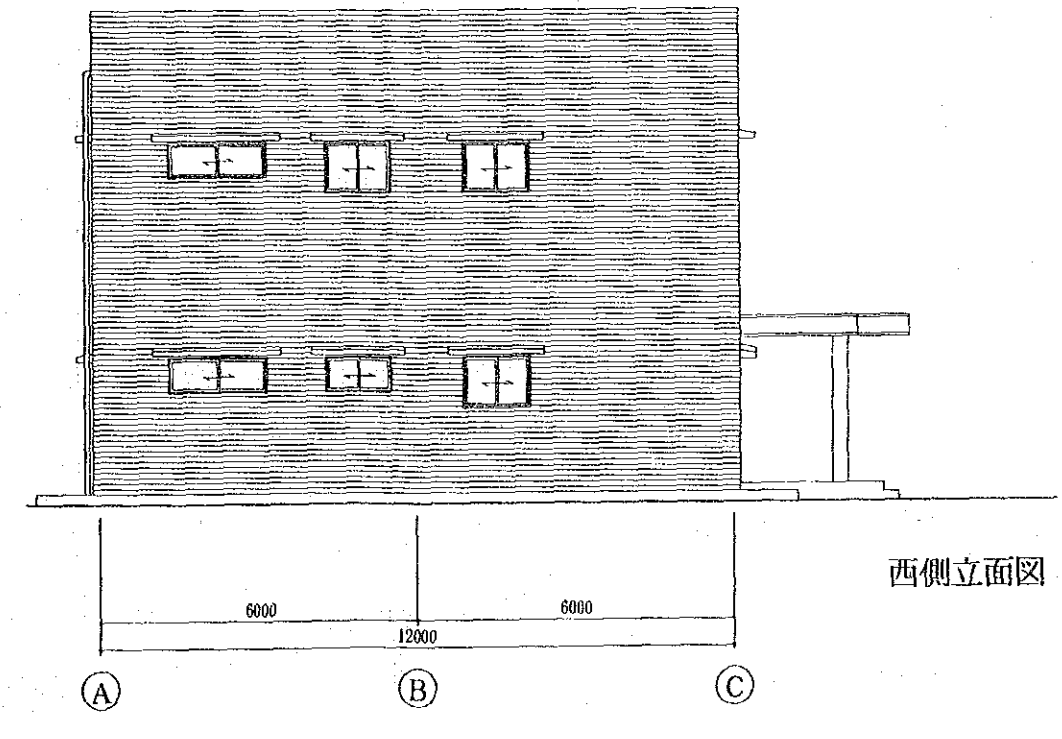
レーダー運用局舎立面/断面図 (1)
